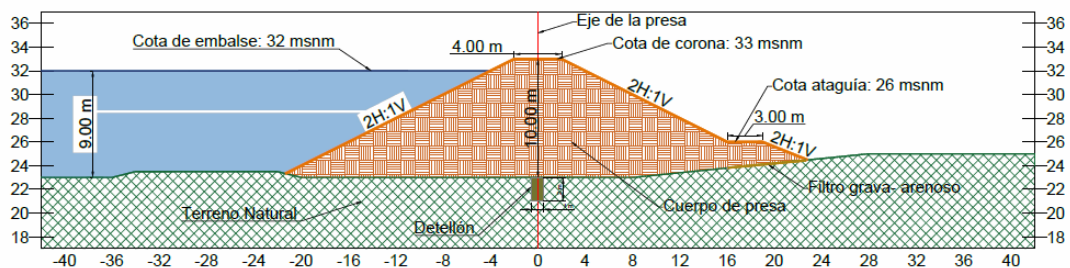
Sección típica de la presa colinar, [Elaboración propia, 2021]
